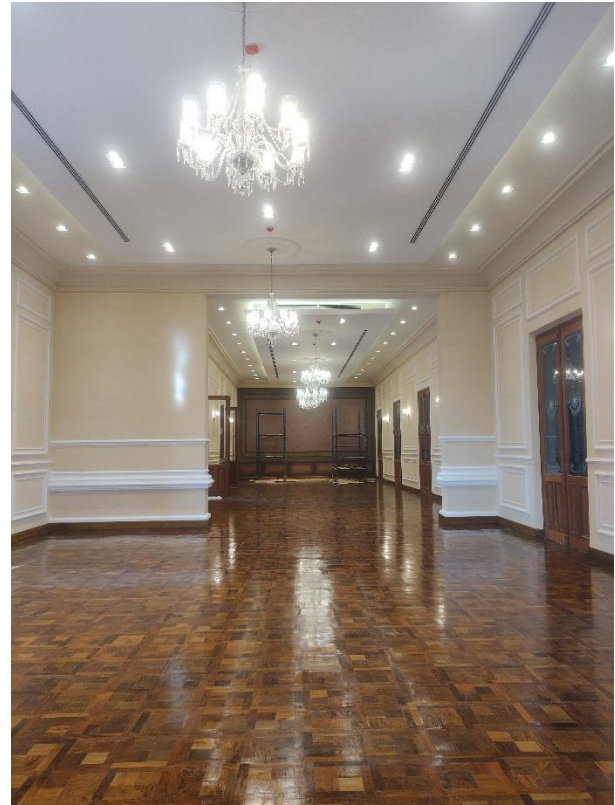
Paredes del salon principal de la planta baja completamente restaurados y los pisos de parquet en proceso de pulido.
